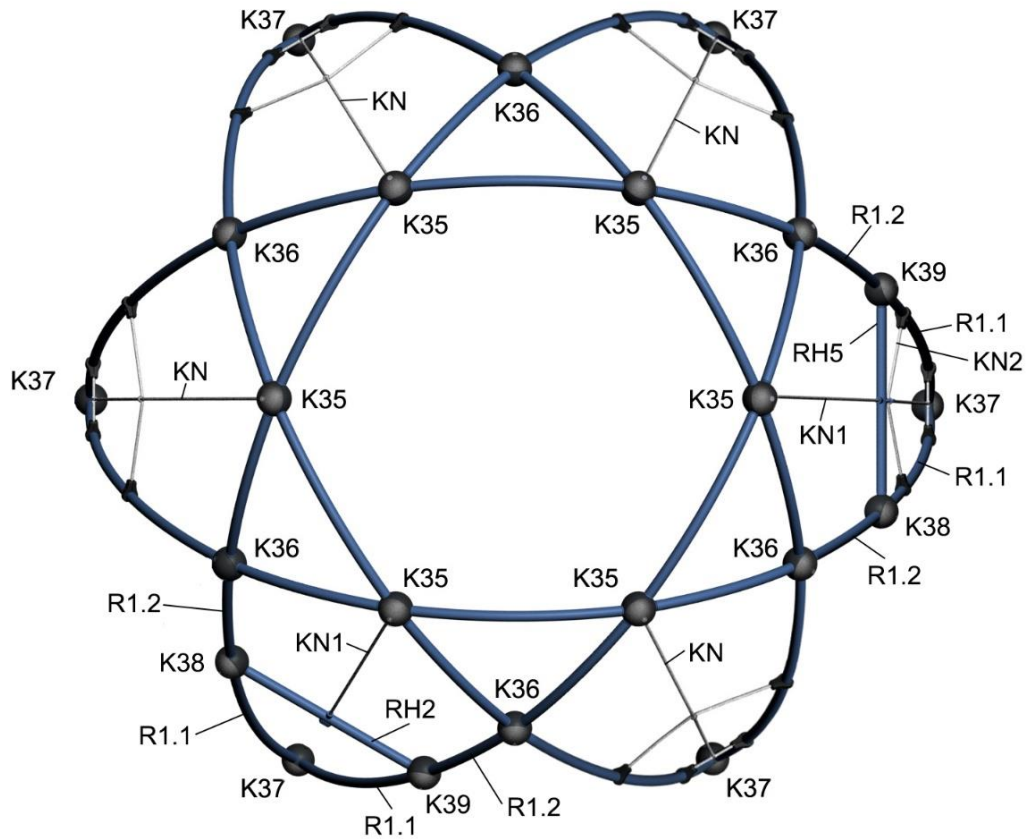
Draufsicht mit Bezeichnung der Rohre, Hohlkugeln und Netze
